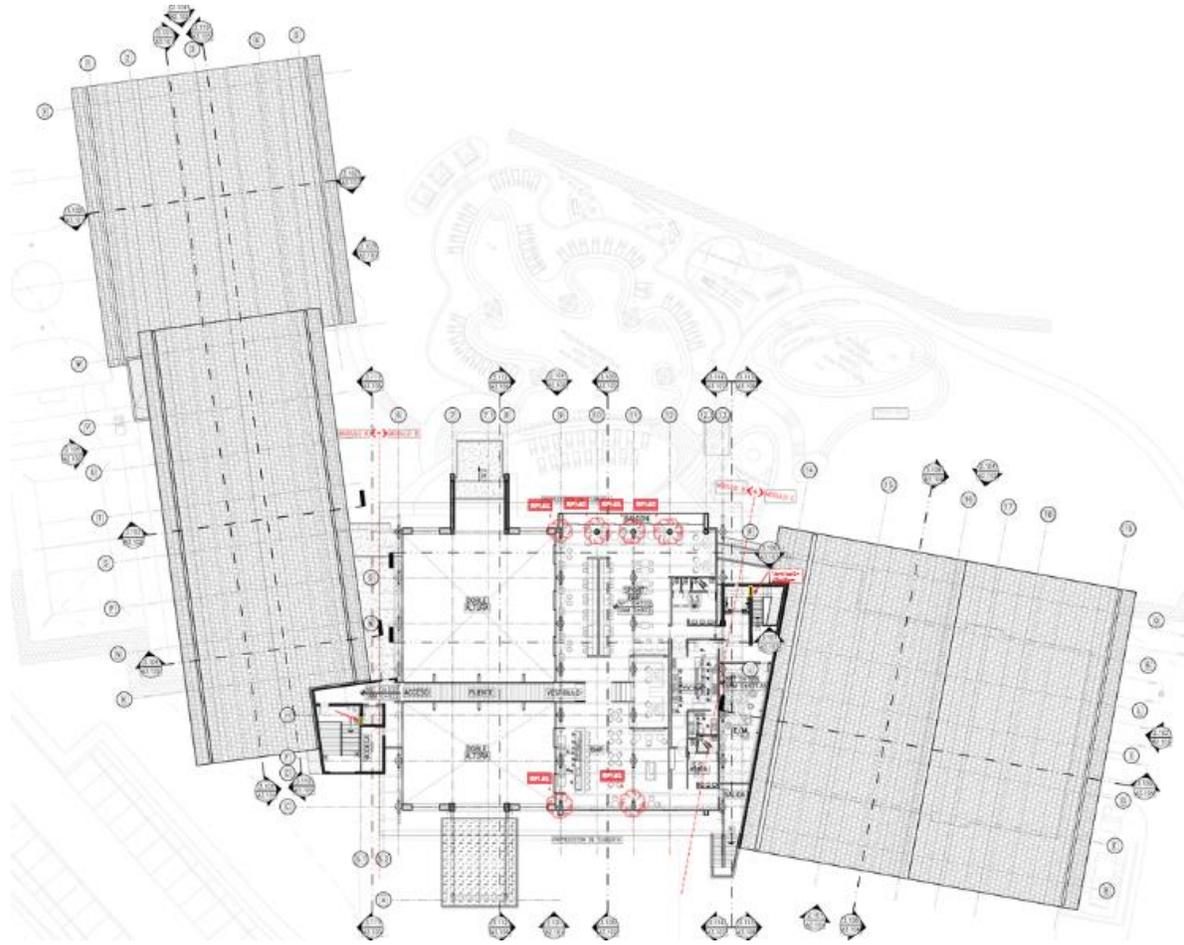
Planta arquitectónica de los tres módulos, nivel 922 (100). Fuente: EDIFICAR, 2018.
